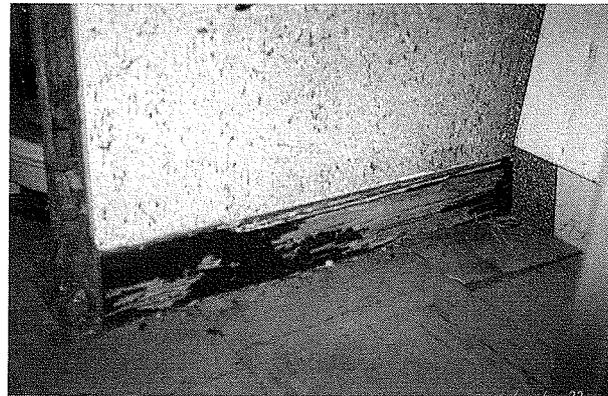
鉄筋コンクリート造建物内部のイエシロアリによる被害
